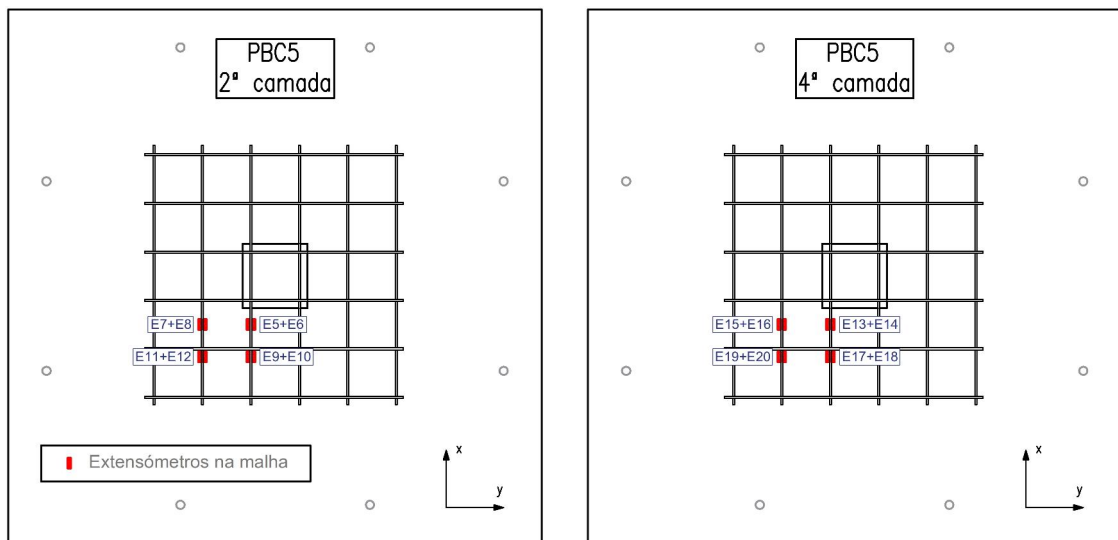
Localização e numeração dos extensômetros nas armaduras do tipo malha da Laje PBC5.
